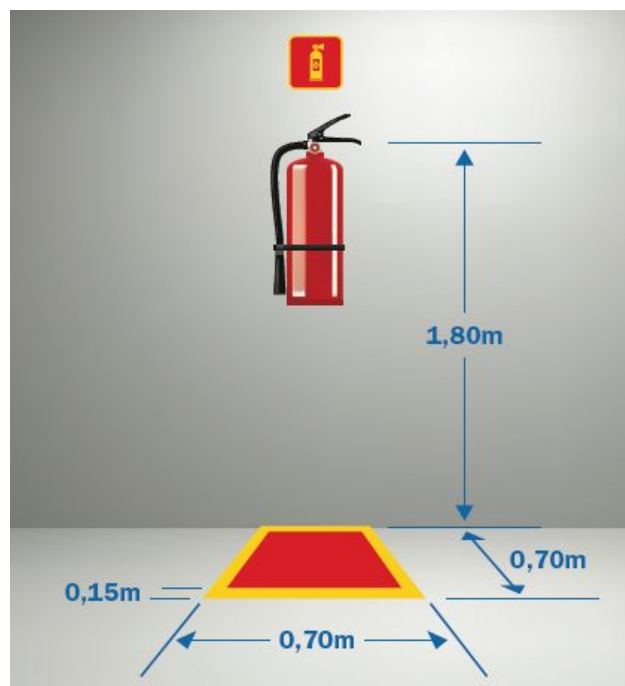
Indicação da instalação de extintor em parede e demarcação do piso
